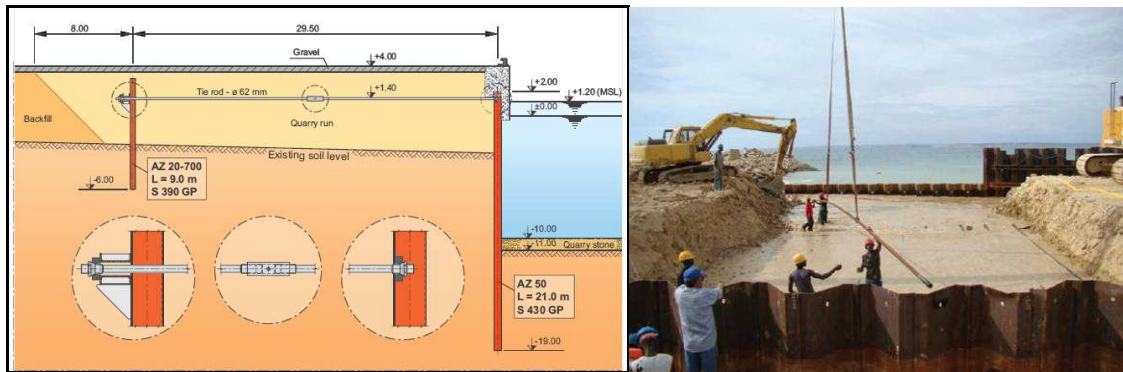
Corte-tipo e construção do Porto Amboim, Angola [64].
